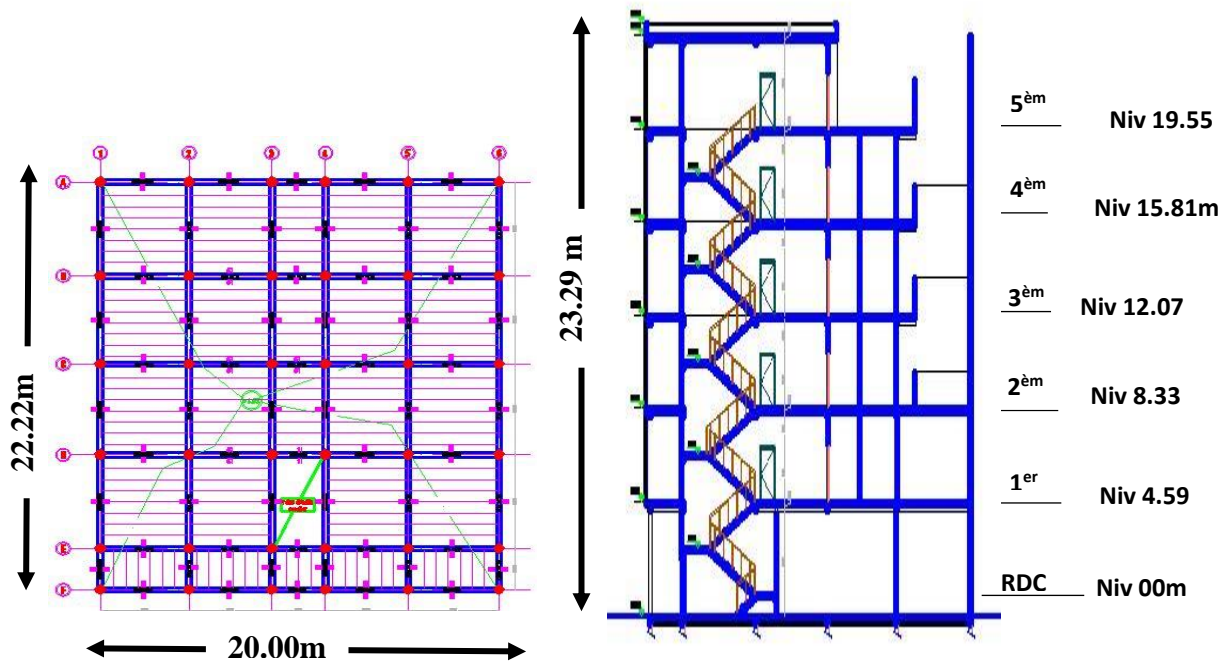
Caractéristiques géométriques en plan et en élévation.
